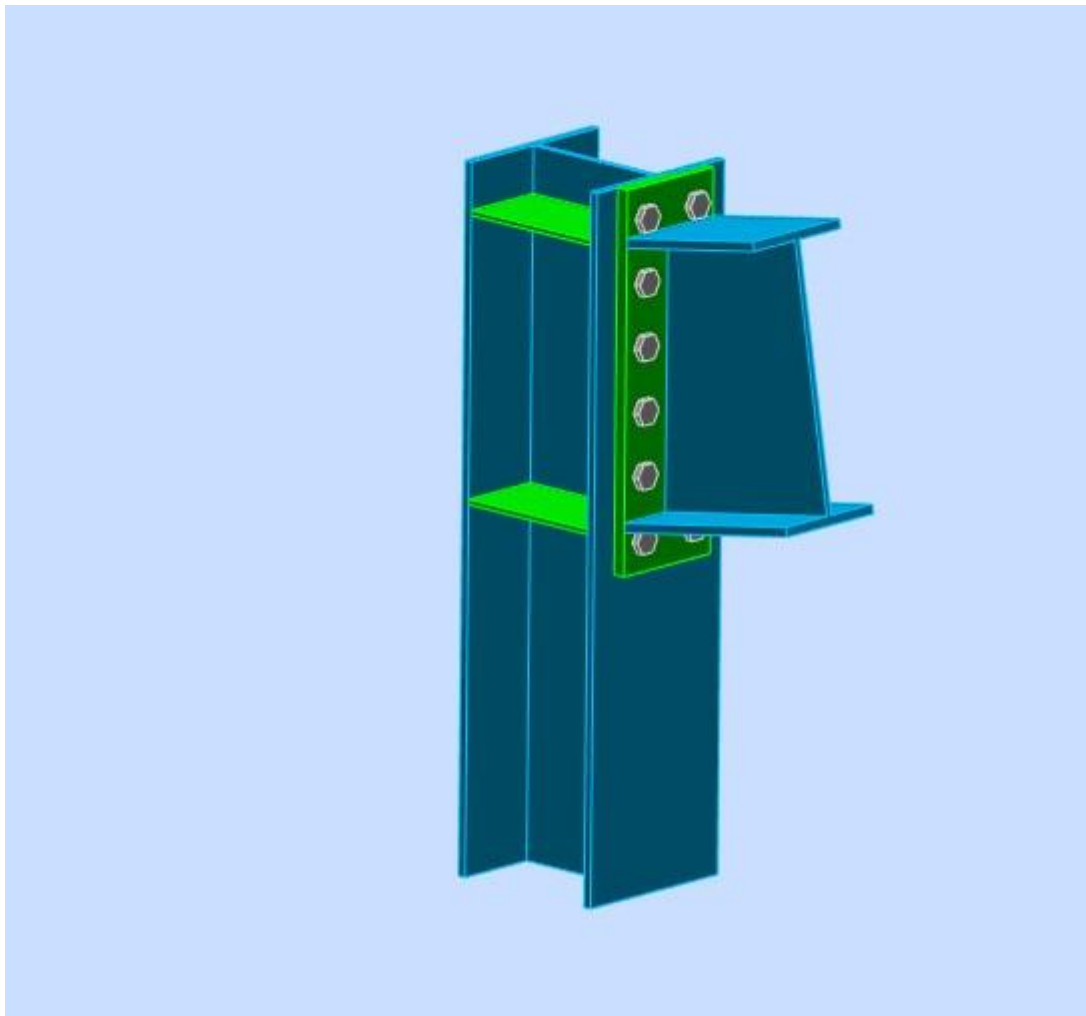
vue 3D d'Assemblage poteau traverse
